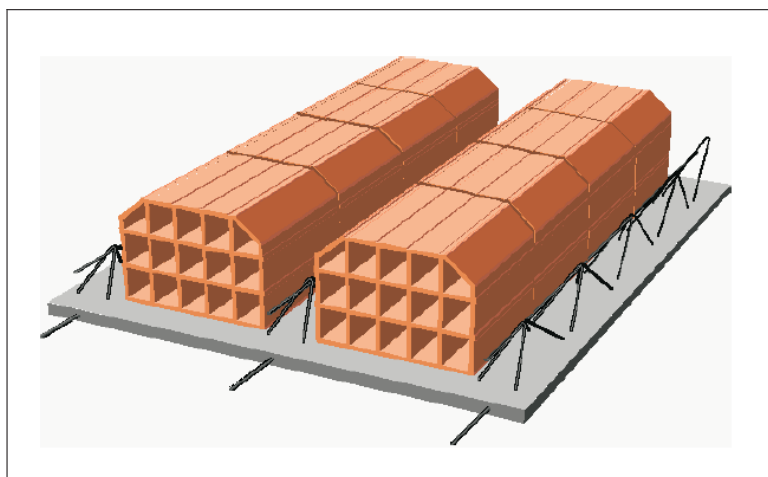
Lastra sovrano a travetti tralicciati e blocchi di laterizio (fonte Laterizificio Pugliese)
